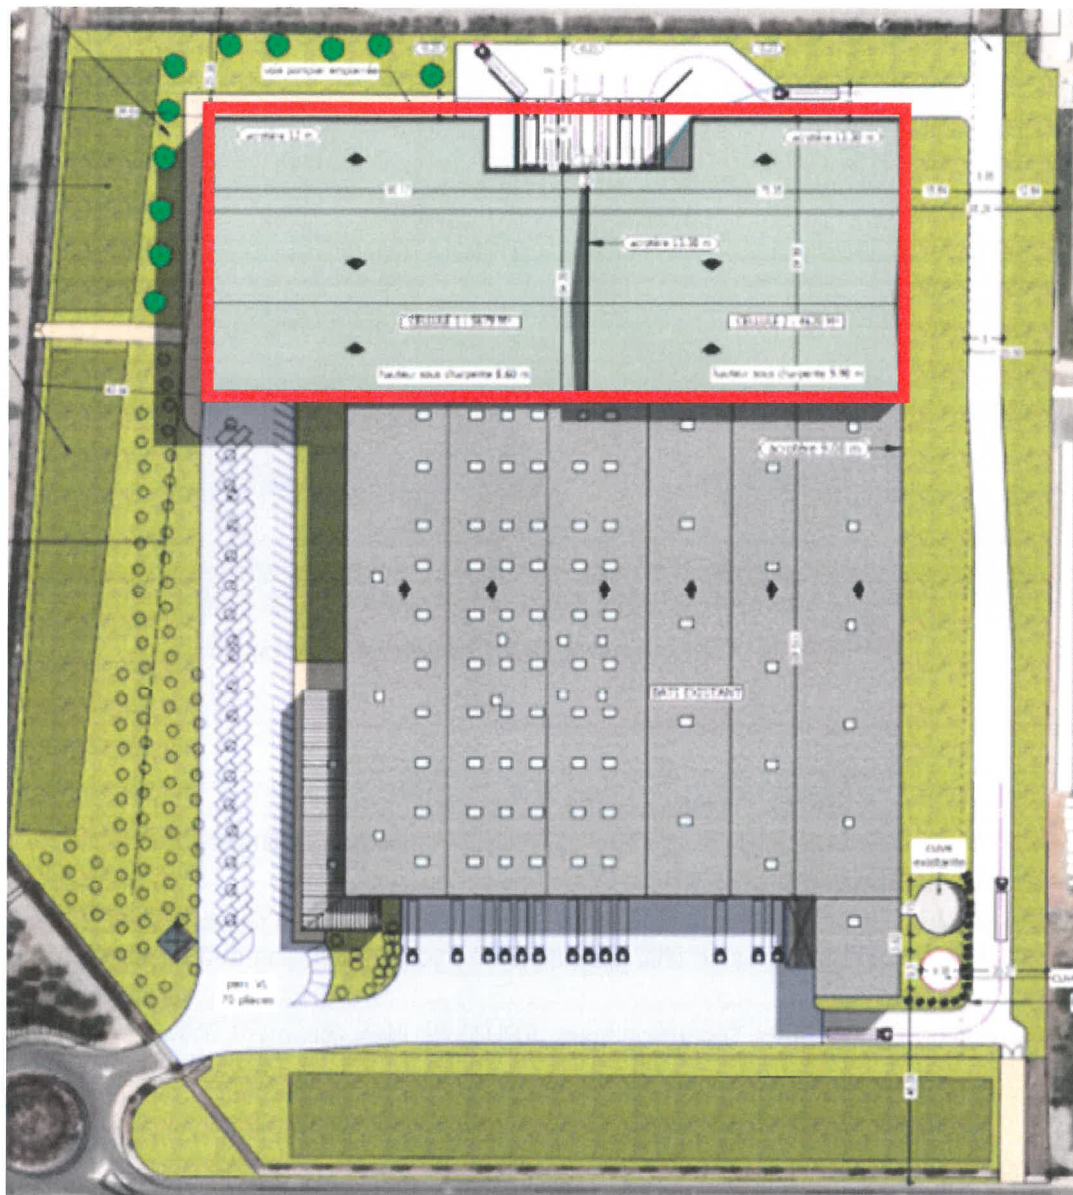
Plan de masse avec l'extension au nord (source : dossier exploitant)
